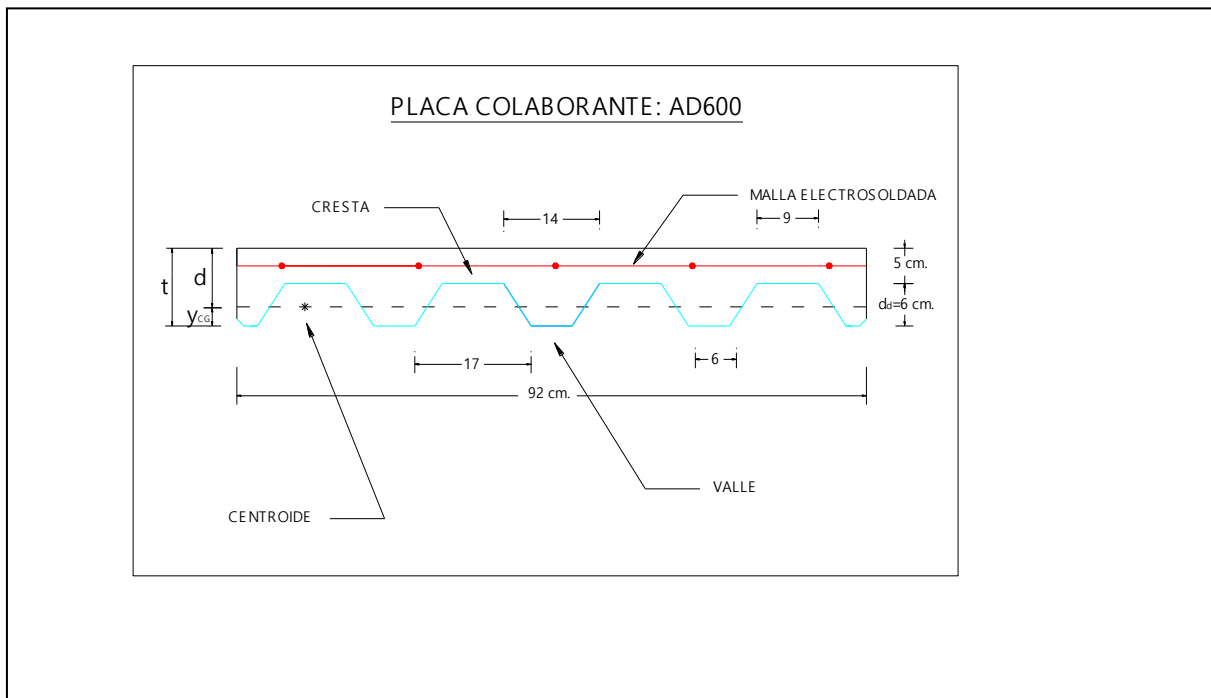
Placa Colaborante AD 600 - Sistema estructural mixto.
